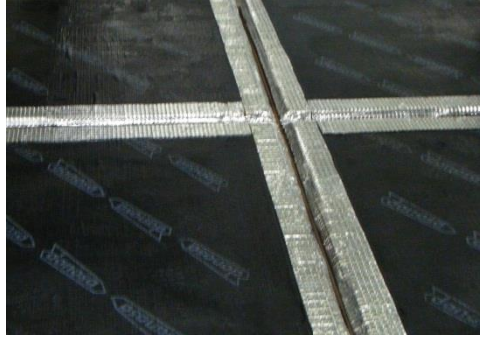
Exemple de protection de joint de terrasse-jardin
